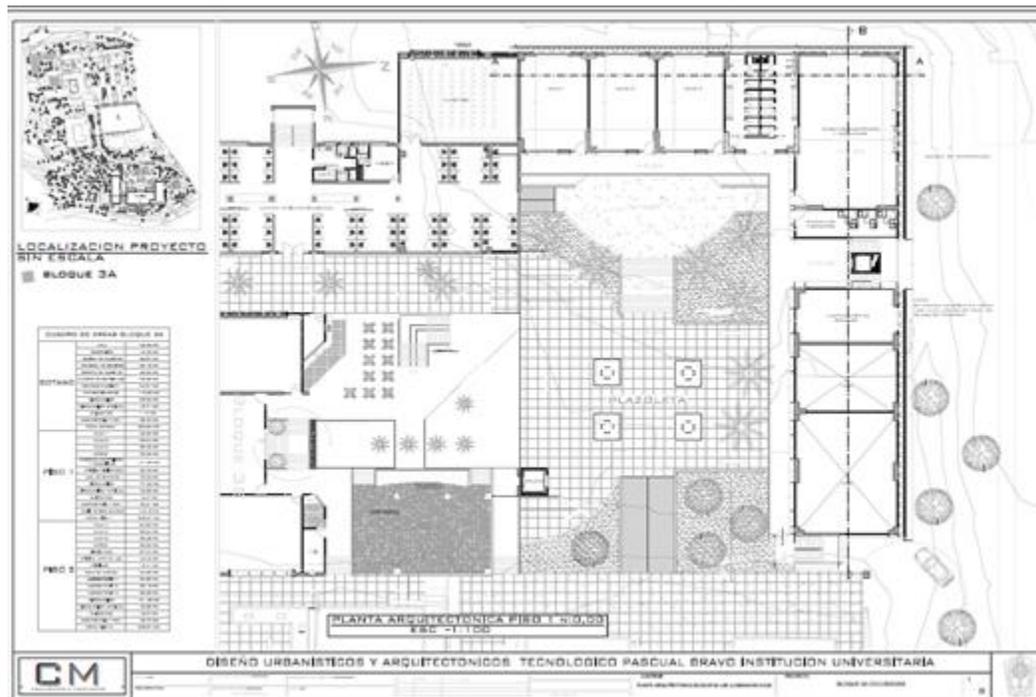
Planta propuesta general para el Laboratorio de Iluminación del ITPB - I.U.
